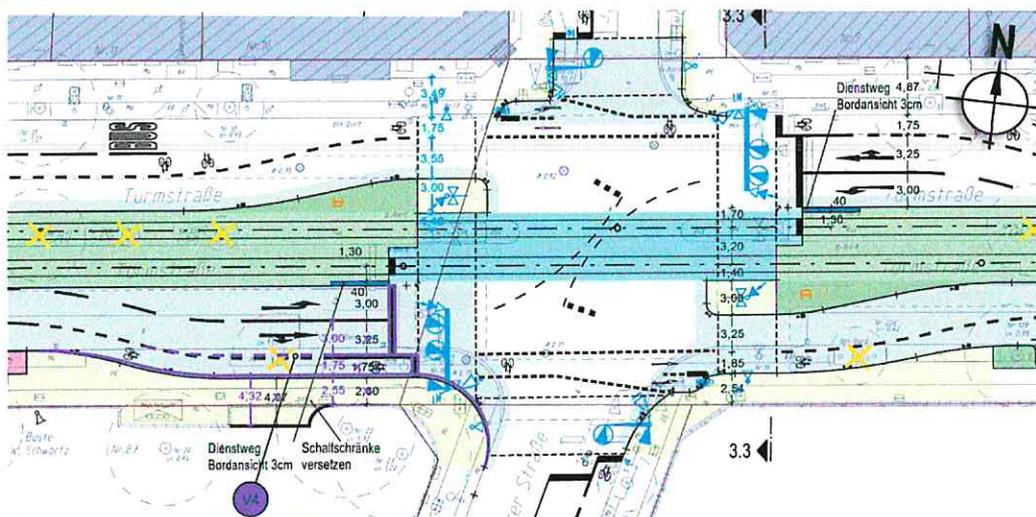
Lageplan Knoten Turmstraße / Wilsnacker Straße (mit Änderung Fahrstreifenbreite)
